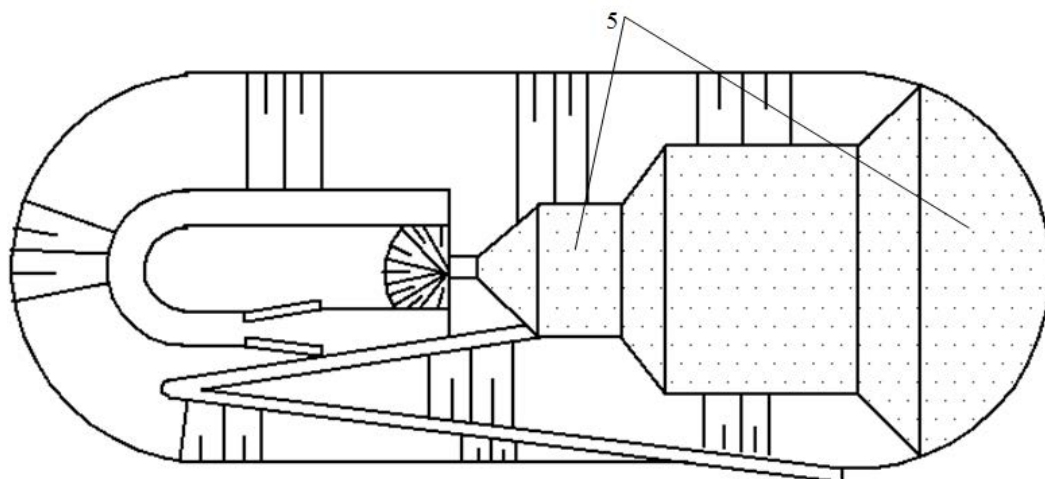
План карьера на момент его доработки и формирования внутреннего отвала
